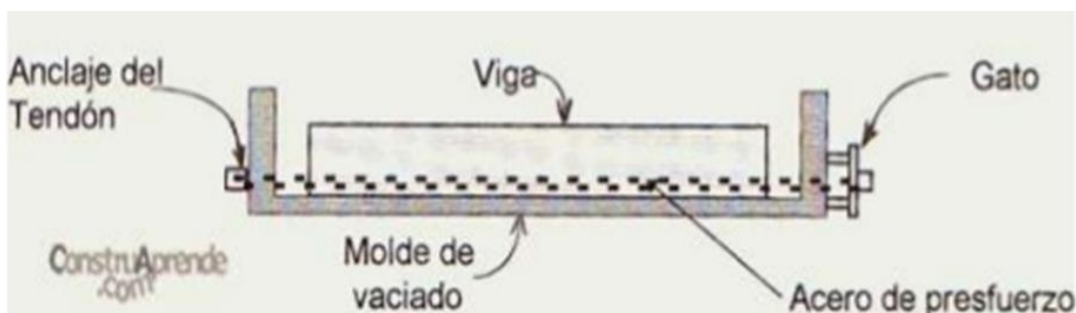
Ejemplo de armado de hormigón pretensado. [I-9]
